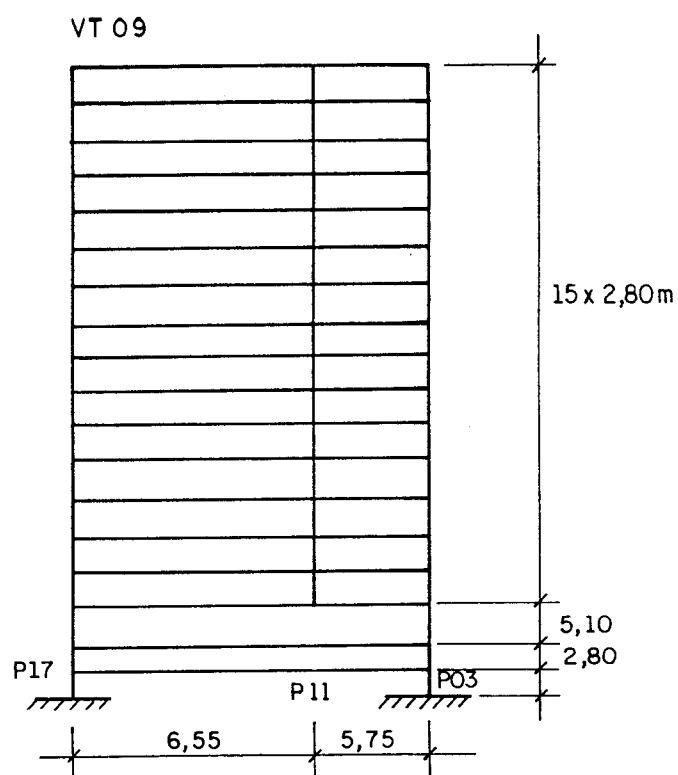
Pórtico plano com a viga VT09 a partir do 4.^o pavimento
